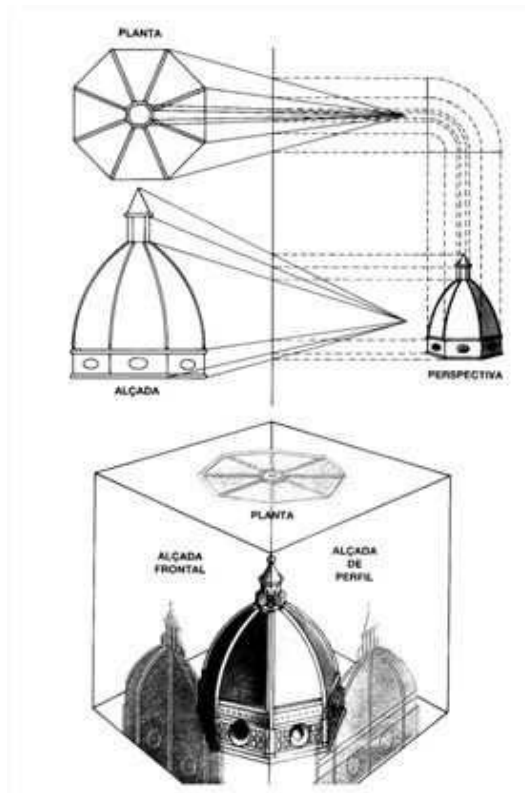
Esquema de Brunelleschi: perspectiva através do desenho em planta e do alçado.
